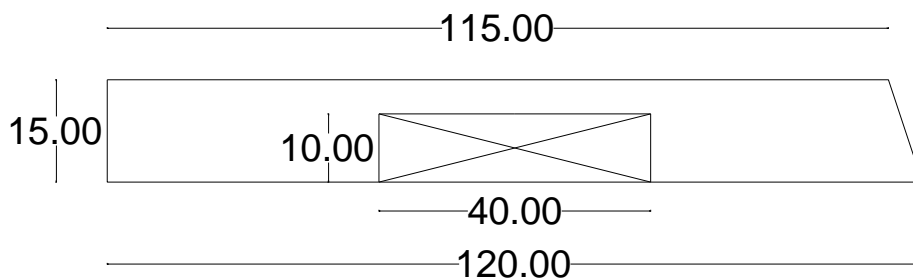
Vista transversal de la geometría de acera, en centímetros. Elaborado por: Autores.
